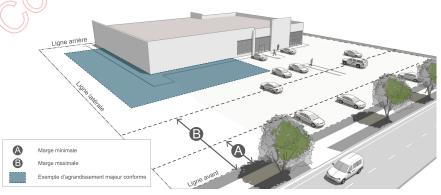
Agrandissement majeur d'une construction dérogatoire à la marge avant maximale
